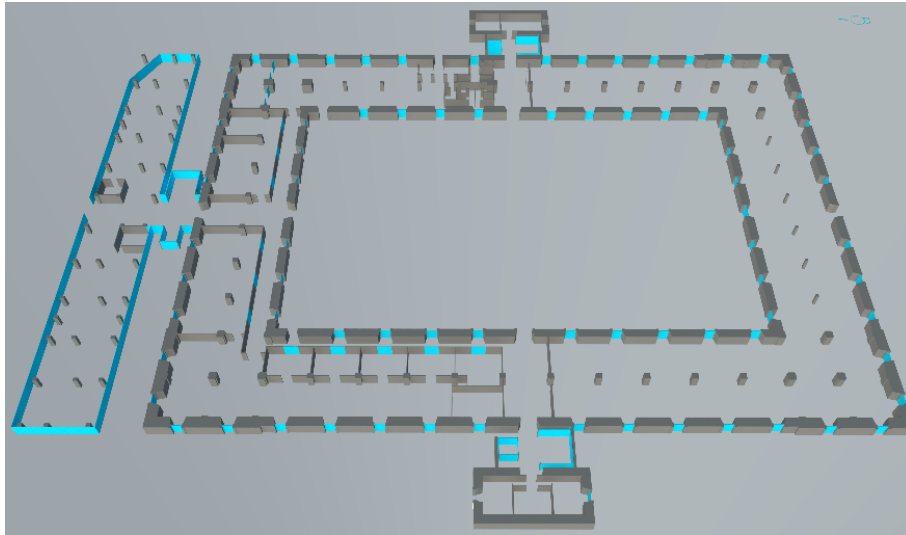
Plano Planta Baja del edificio CIM mostrado en SketchUp renderizado mediante V-Ray
